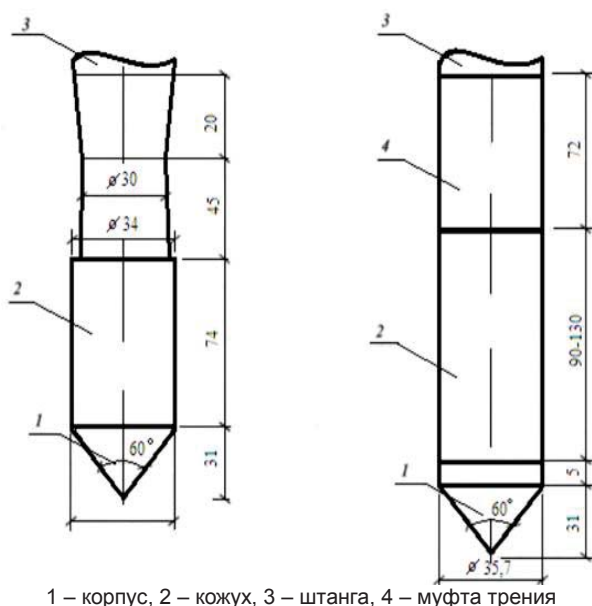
Схемы конструкций зондов для статического зондирования грунтов
